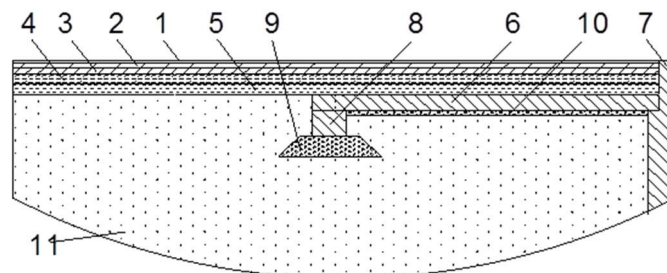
Схема сполучення мостової споруди з насипом підходу: 1-3 - шари асфальтобетонного покриття; 4-5 - шари основи; 6 - перехідна плита; 7 - стоян (берегова опора); 8 - лежень; 9-10 - щебенева подушка; 11 - грунт земляного полотна (дренуючий) – пісок
